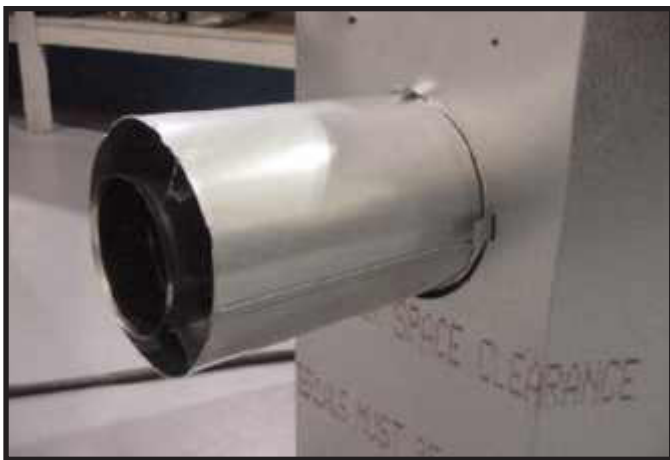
(représentation d'un foyer générique) Posez la première section du conduit d'évacuation (elle s'insérera en place d'un bruit sec). Glissez le joint d'isolation (expédié dans le sac du manuel) sur cette section du conduit, contre l'appareil, en passant sur les languettes.
